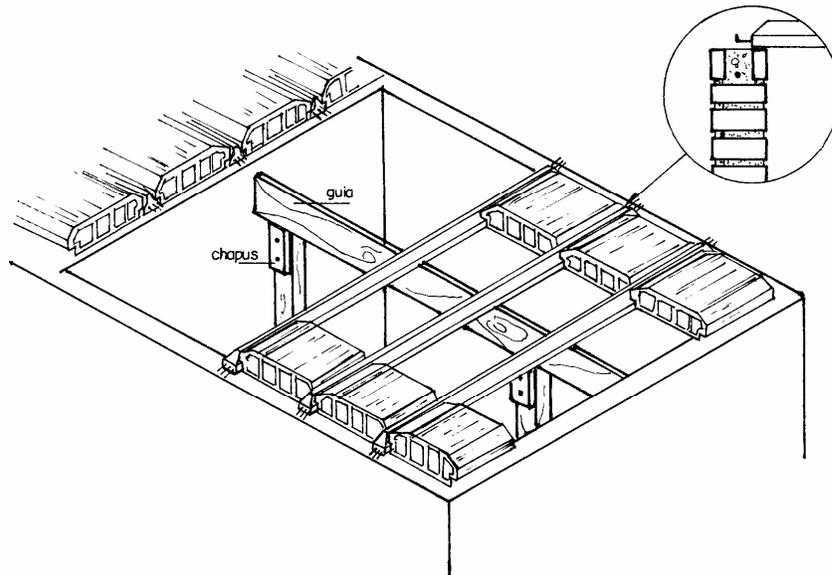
Detalhe da colocação da laje pré-fabricada
